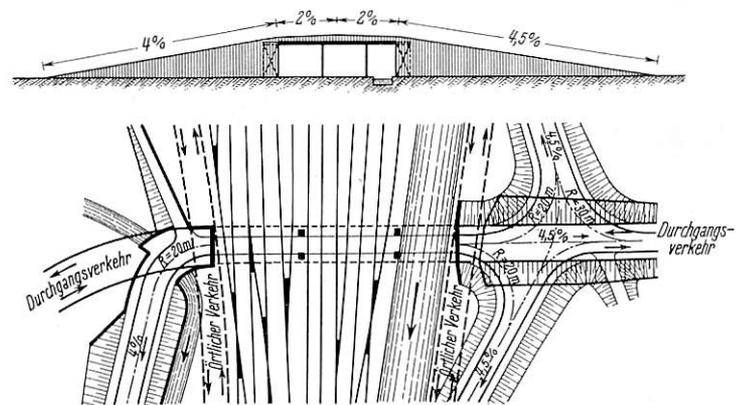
Straßenführung über einen Bahnhof. (Bestehende Anlage und Umbauplan.)
